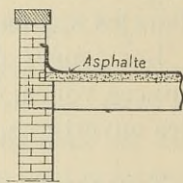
Appui d'une terrasse sur un mur en briques.
